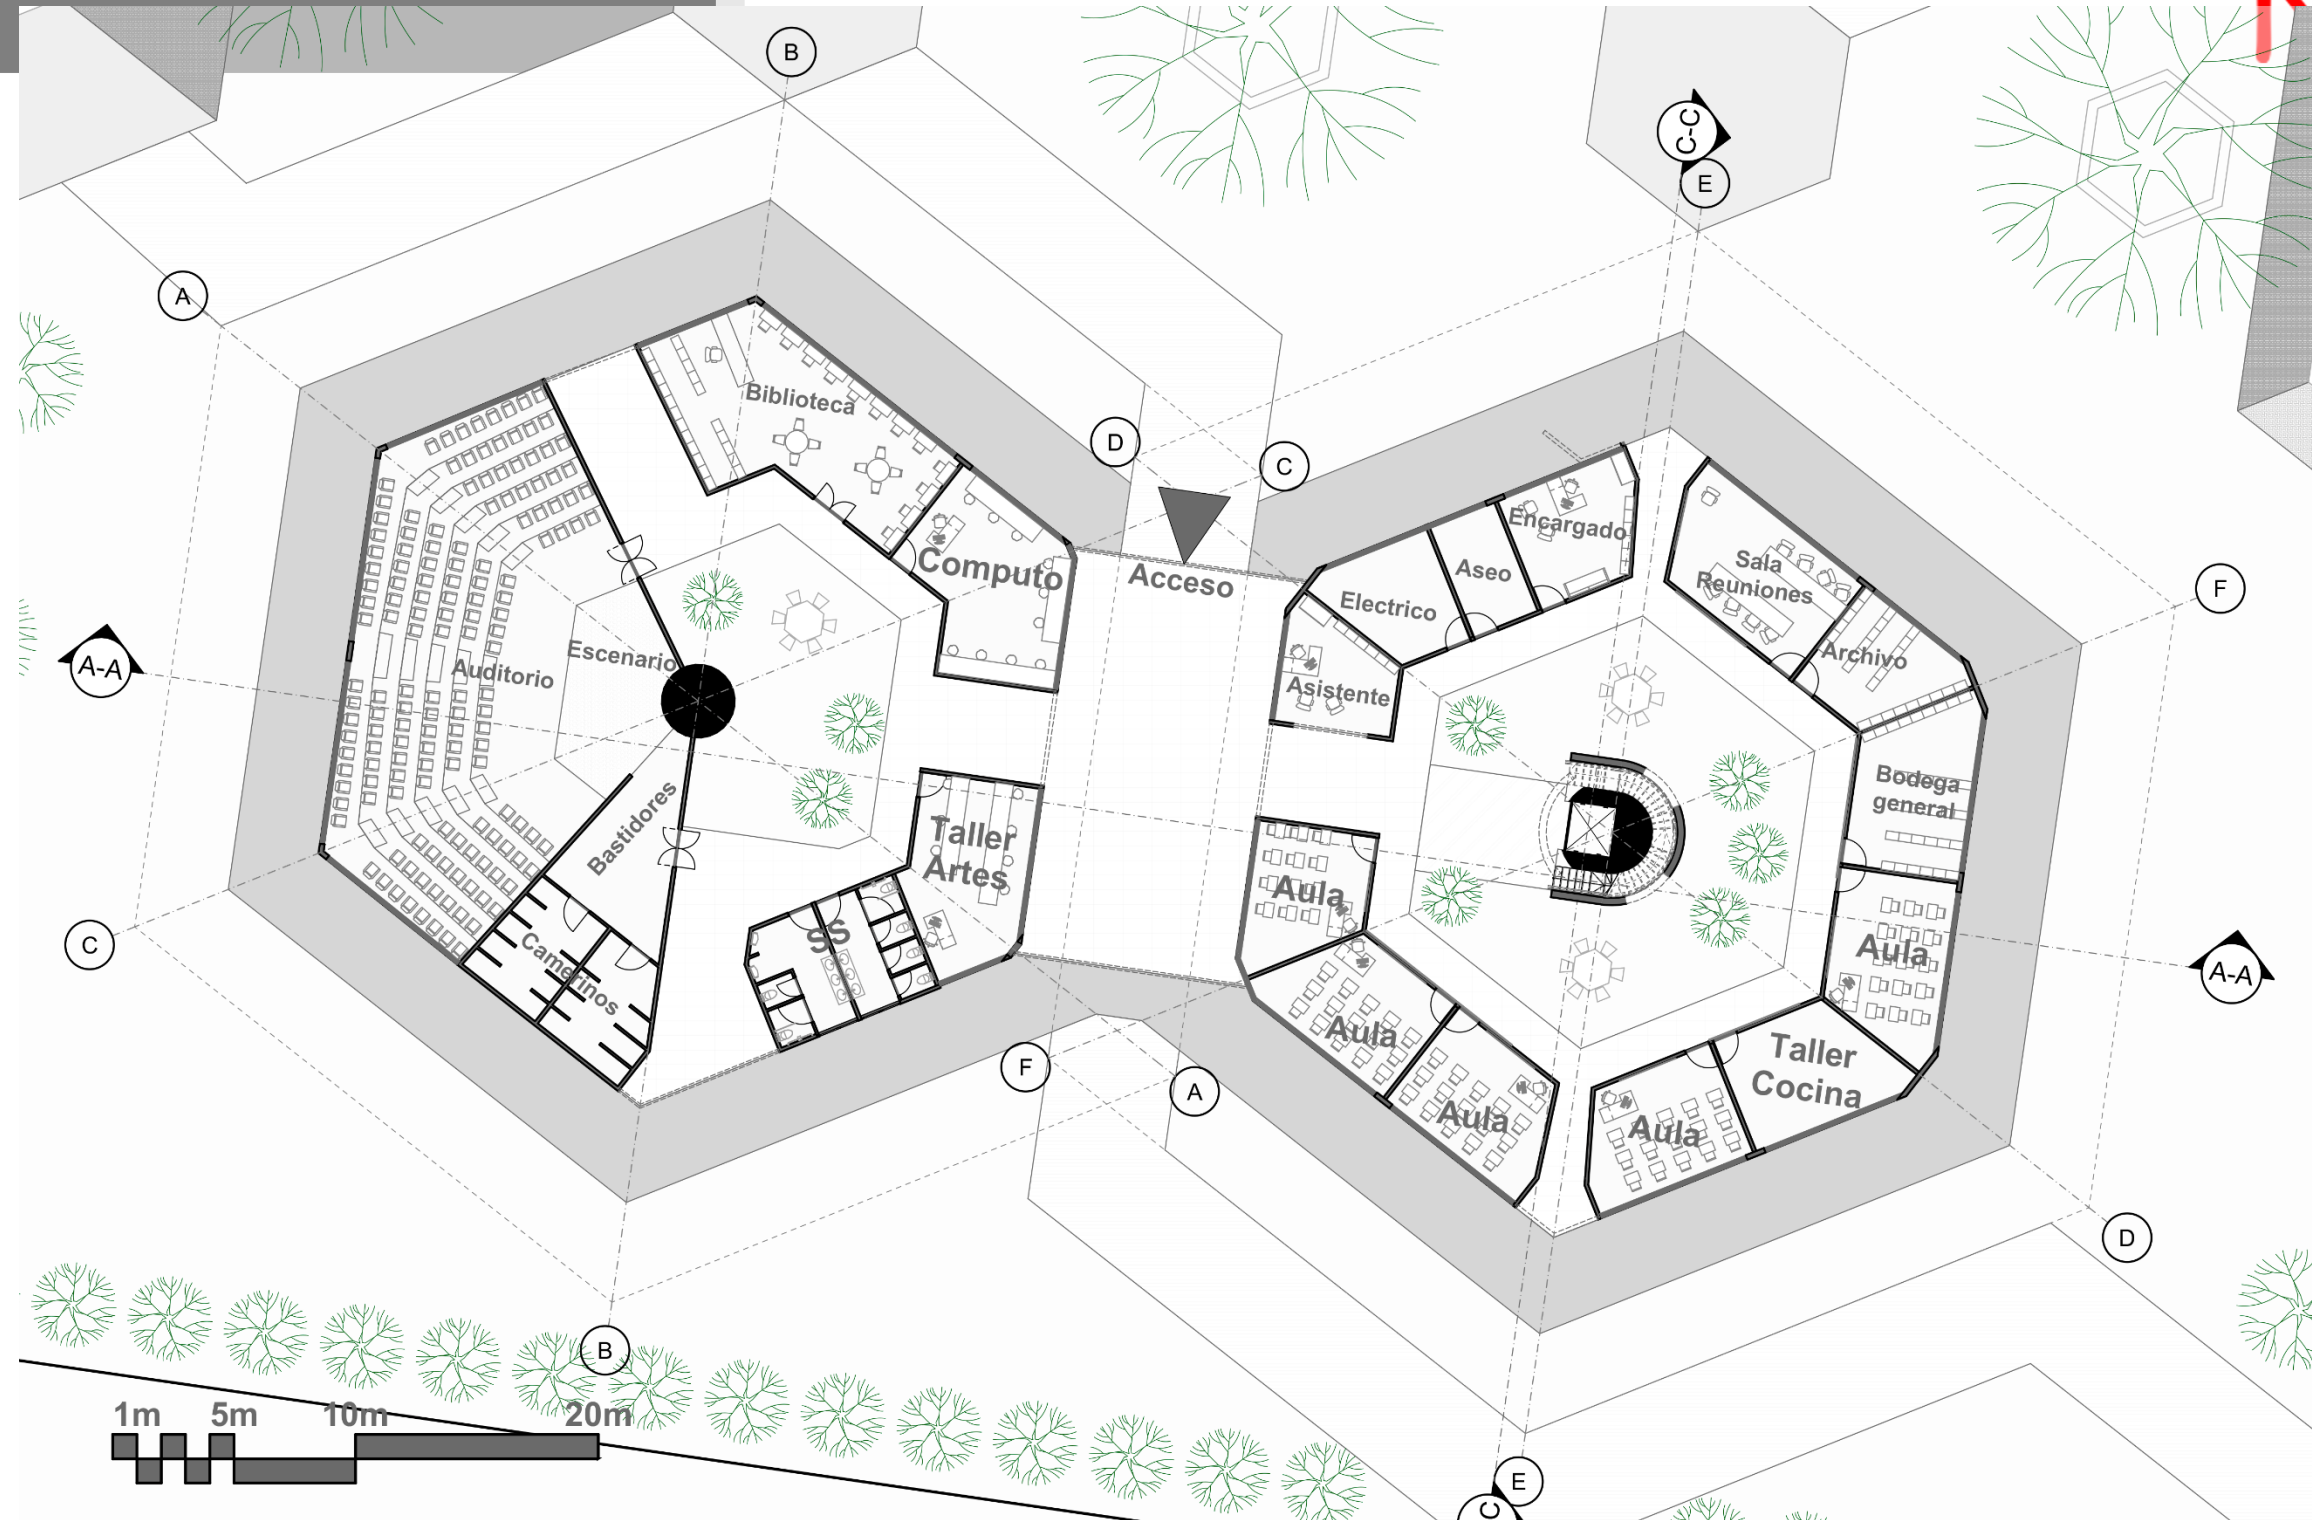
, Planta Arquitectónica Edificio Cultural, Propiedad Personal, Tomado 2023
